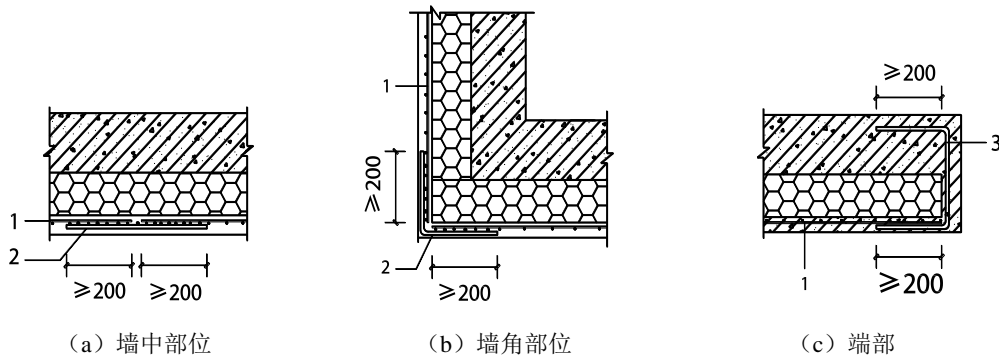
防护层钢筋焊接网水平搭接
